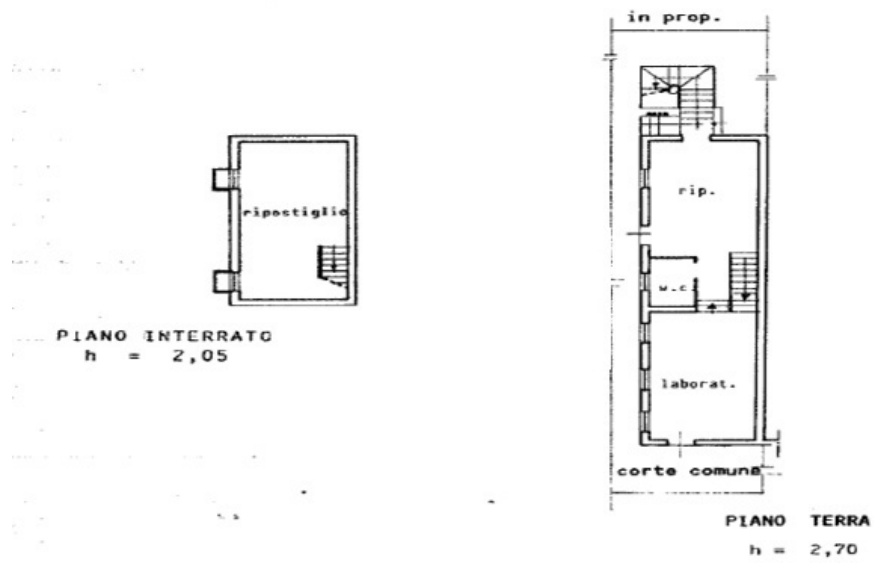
Planimetria Laboratorio p.lla 1193 sub. 1
